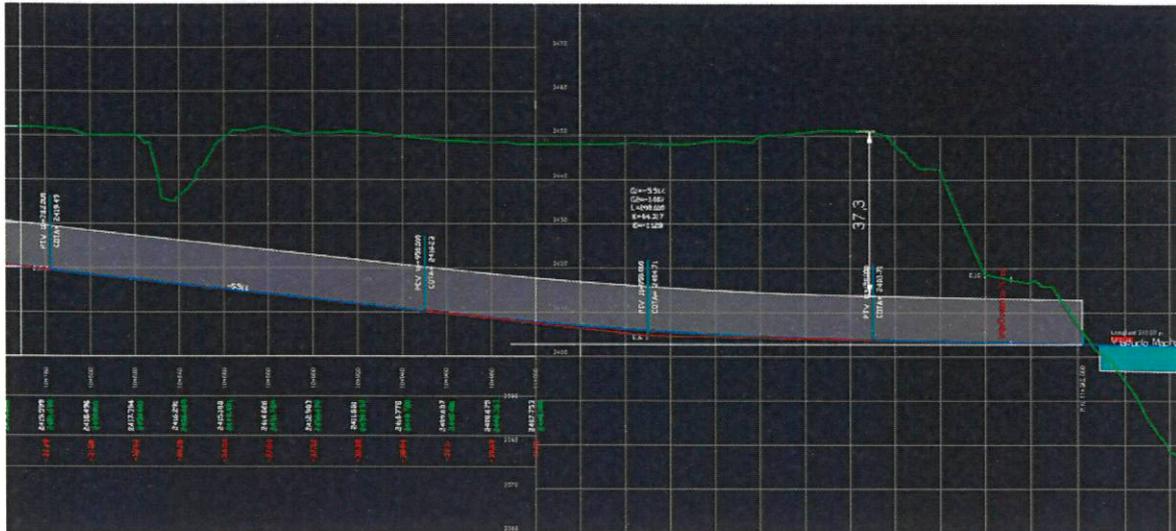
Perfil del tramo de túnel falso del proyecto vial perimetral Metropolitana
